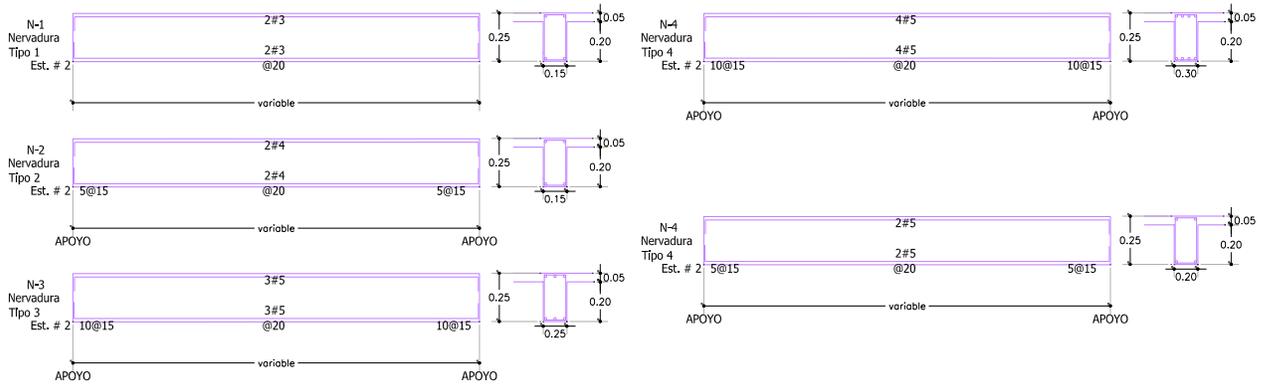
Secciones y Armados de Nervaduras Tipo.
